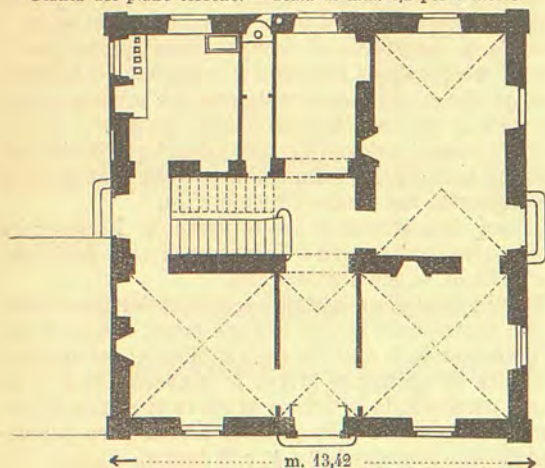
Palazzina Bressi a Giaveno (architetto Reyceud).
